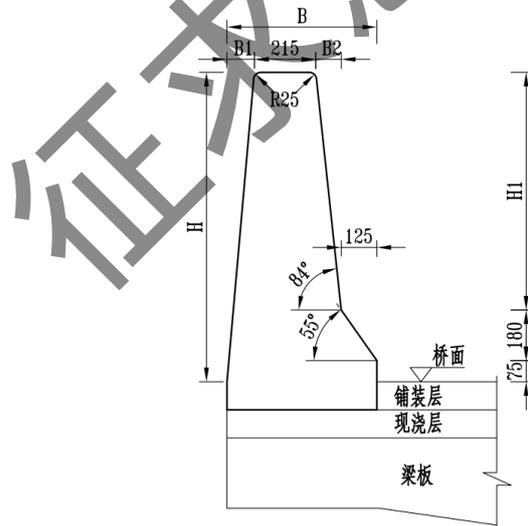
F 型桥梁玻璃纤维钢筋混凝土护栏一般构造示例（单位：mm）
